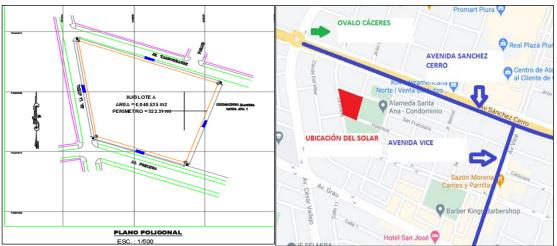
Plano Poligonal del Plano Catastral. Fuente: Oficina de Catrasto Piura y plano de Ubicación de las principales avenidas. Fuente: Elaboración Propia desde Google maps.
